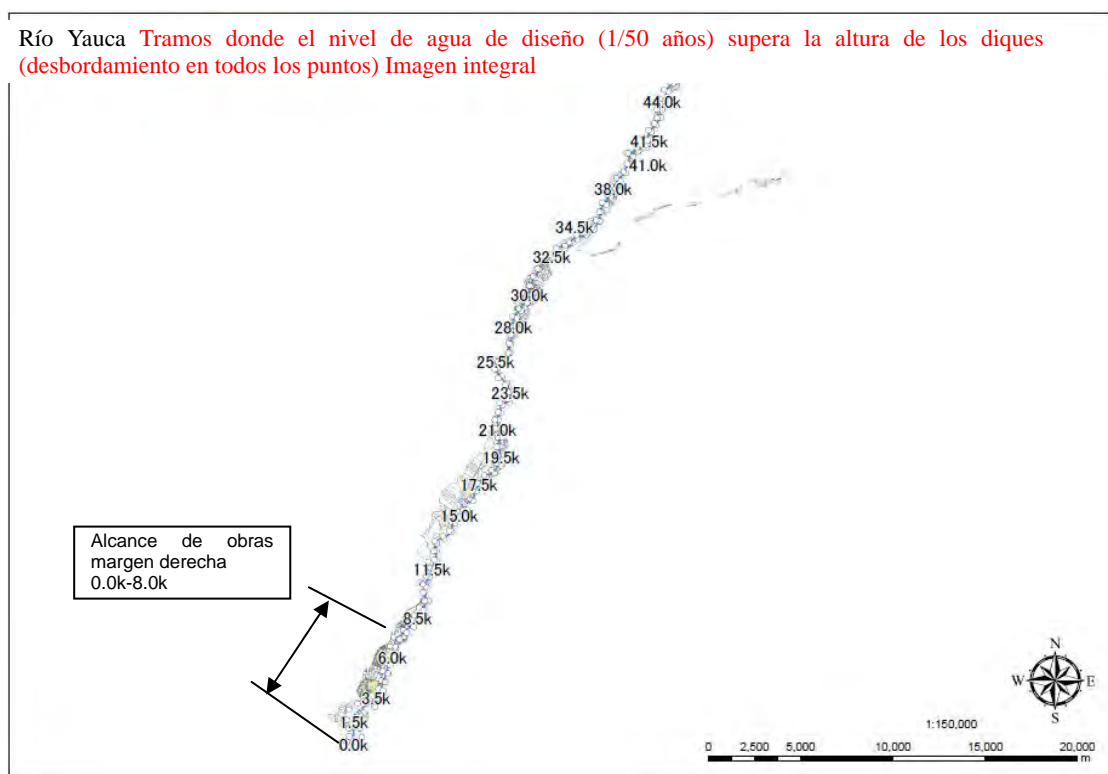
20 Alcance de las obras de construcción de diques en el Río Yauca
